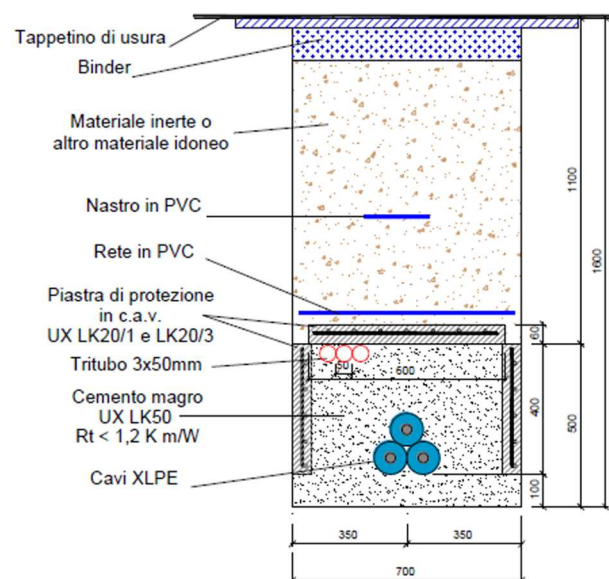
Sezione di posa cavidotto in terreno agricolo e su sede stradale.
